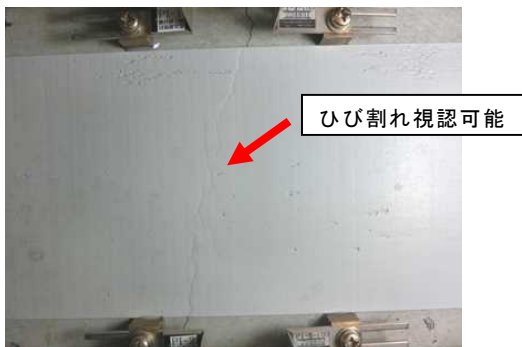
AZY2 ひび割れ発生時 (下面)
